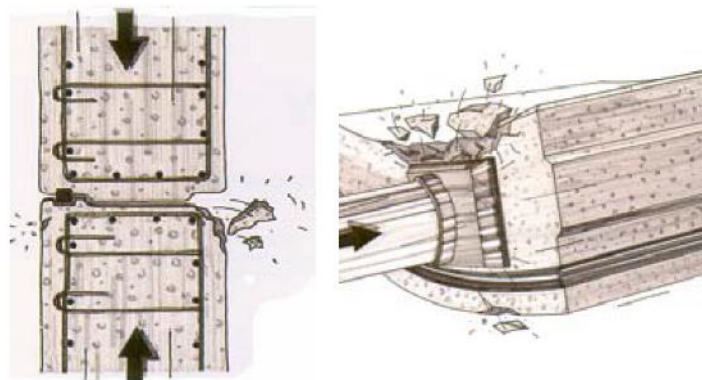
鋼筋混凝土預鑄環片剝落效應[24]
